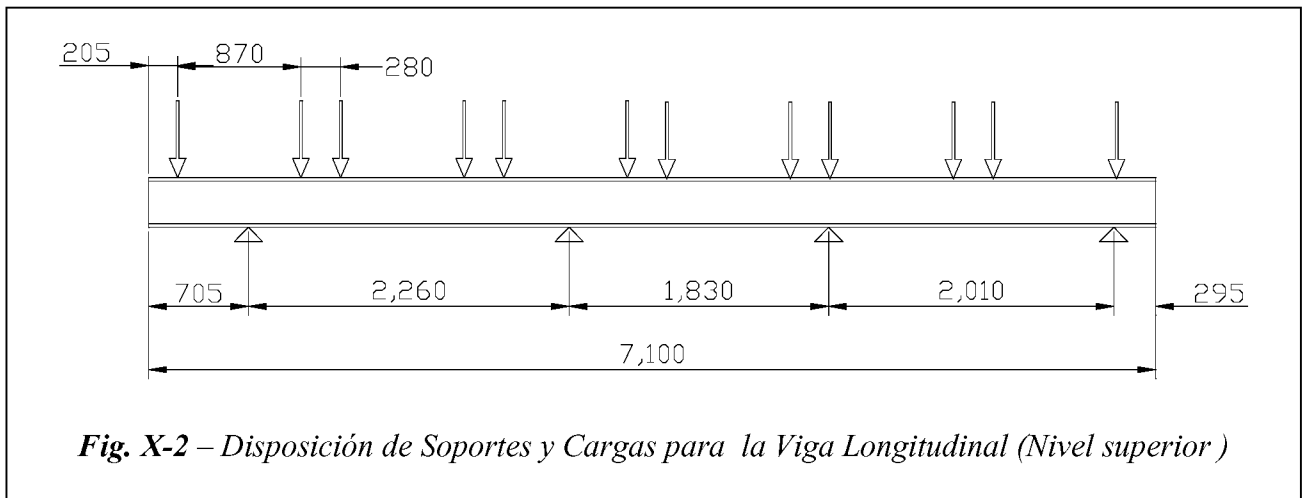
Disposición de Soportes y Cargas para la Viga Longitudinal (Nivel superior)
